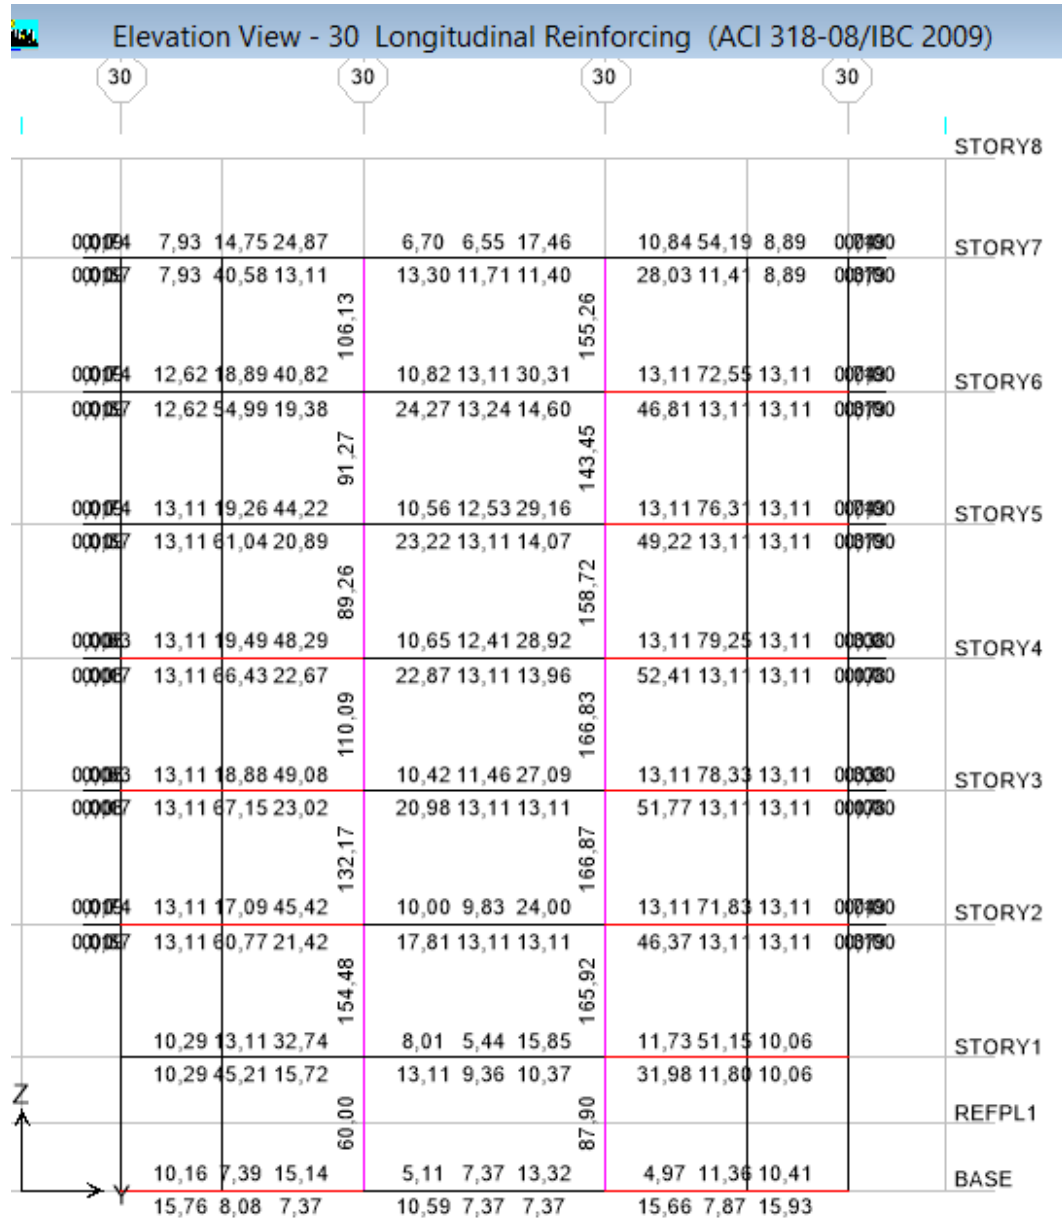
Acero en Vigas y Columnas en el Pórtico 30- Hospitalización 2- (LRB+HDR)
